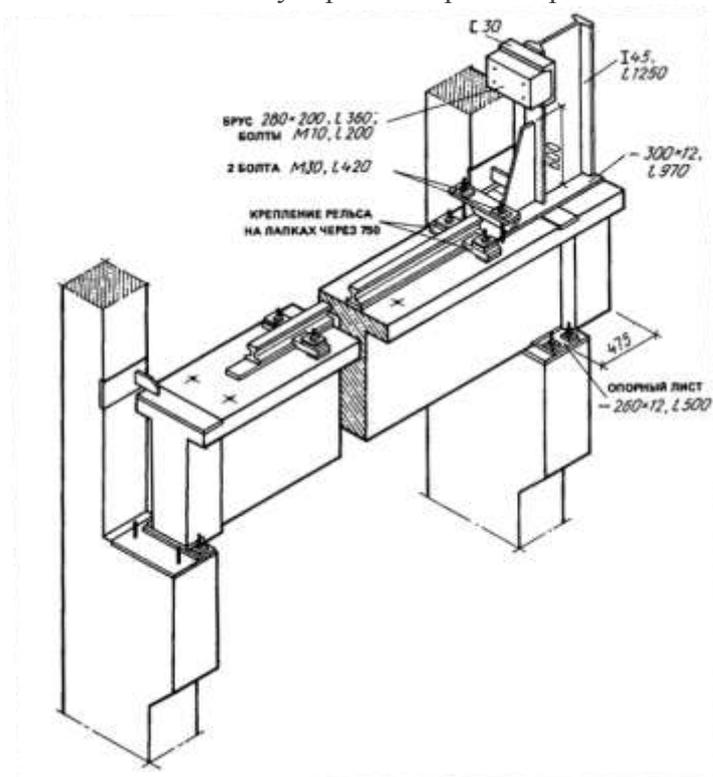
Опирание подкрановой балки на консоль колонны и конструкция концевого упора
